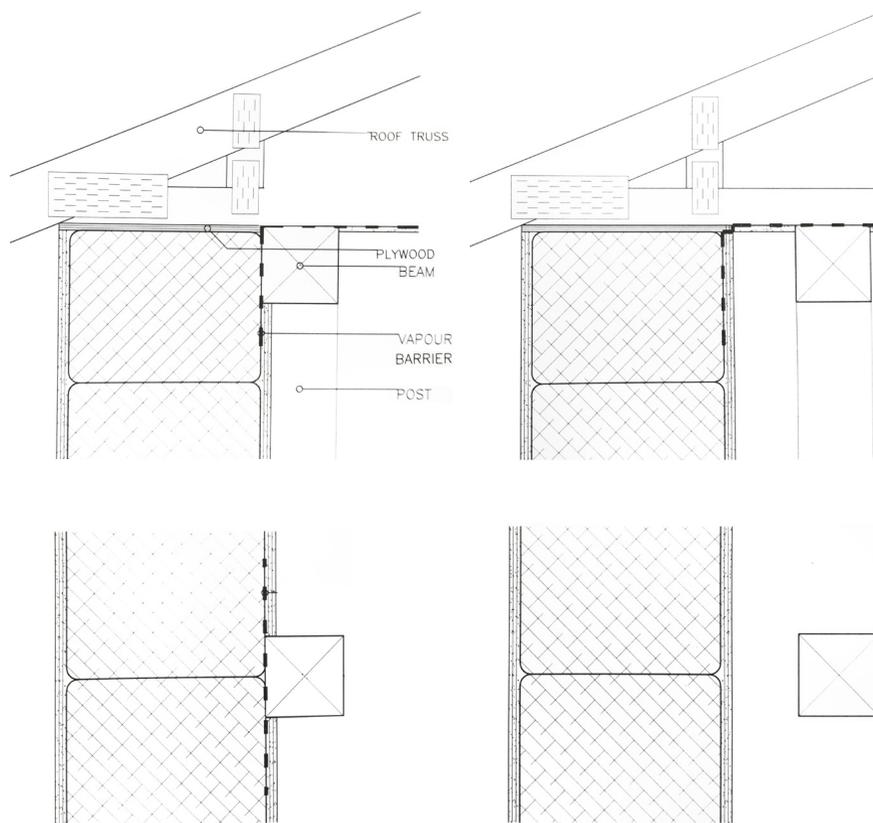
Sistema *Post and Beam*: struttura portante esterna al tamponamento. Piante e sezioni.
